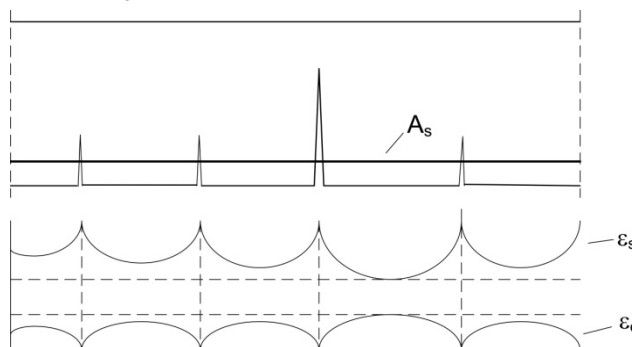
Dehnungsverlauf von Stahl und Beton bei abgeschlossener Rissbildung
